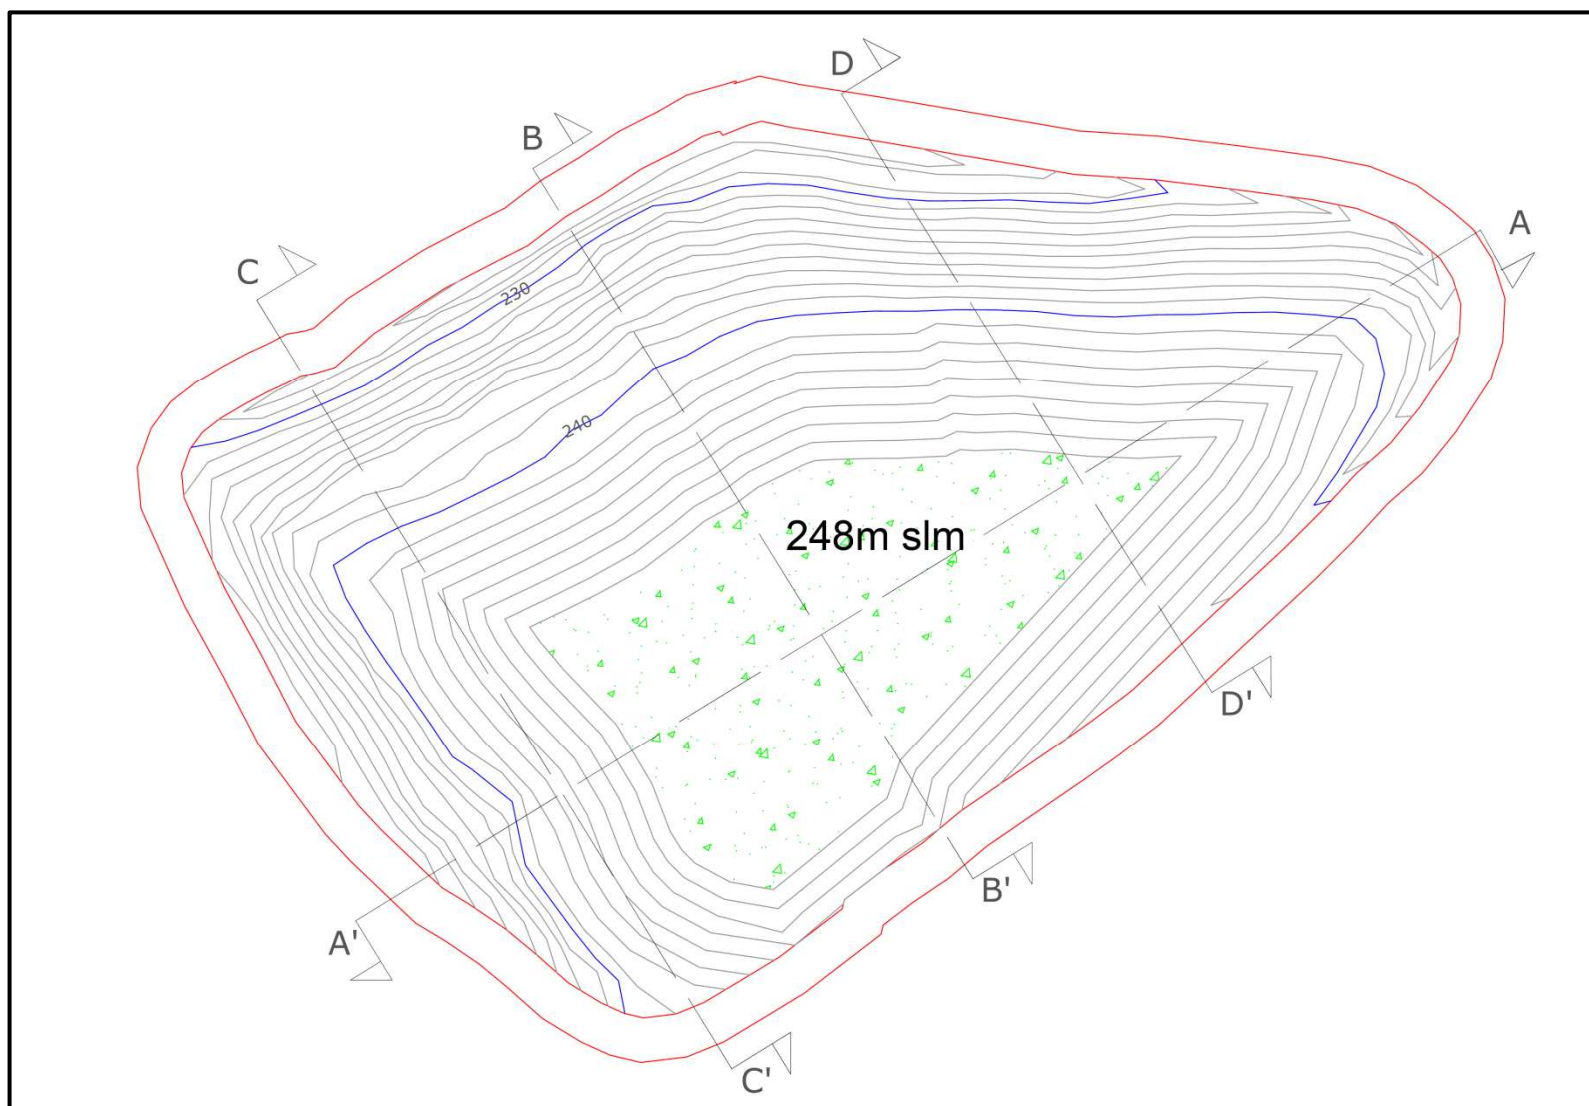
/III: Planimetria Modulo 7 con colmata a quota +248 m slm (rimodellamento in variante 2022).
